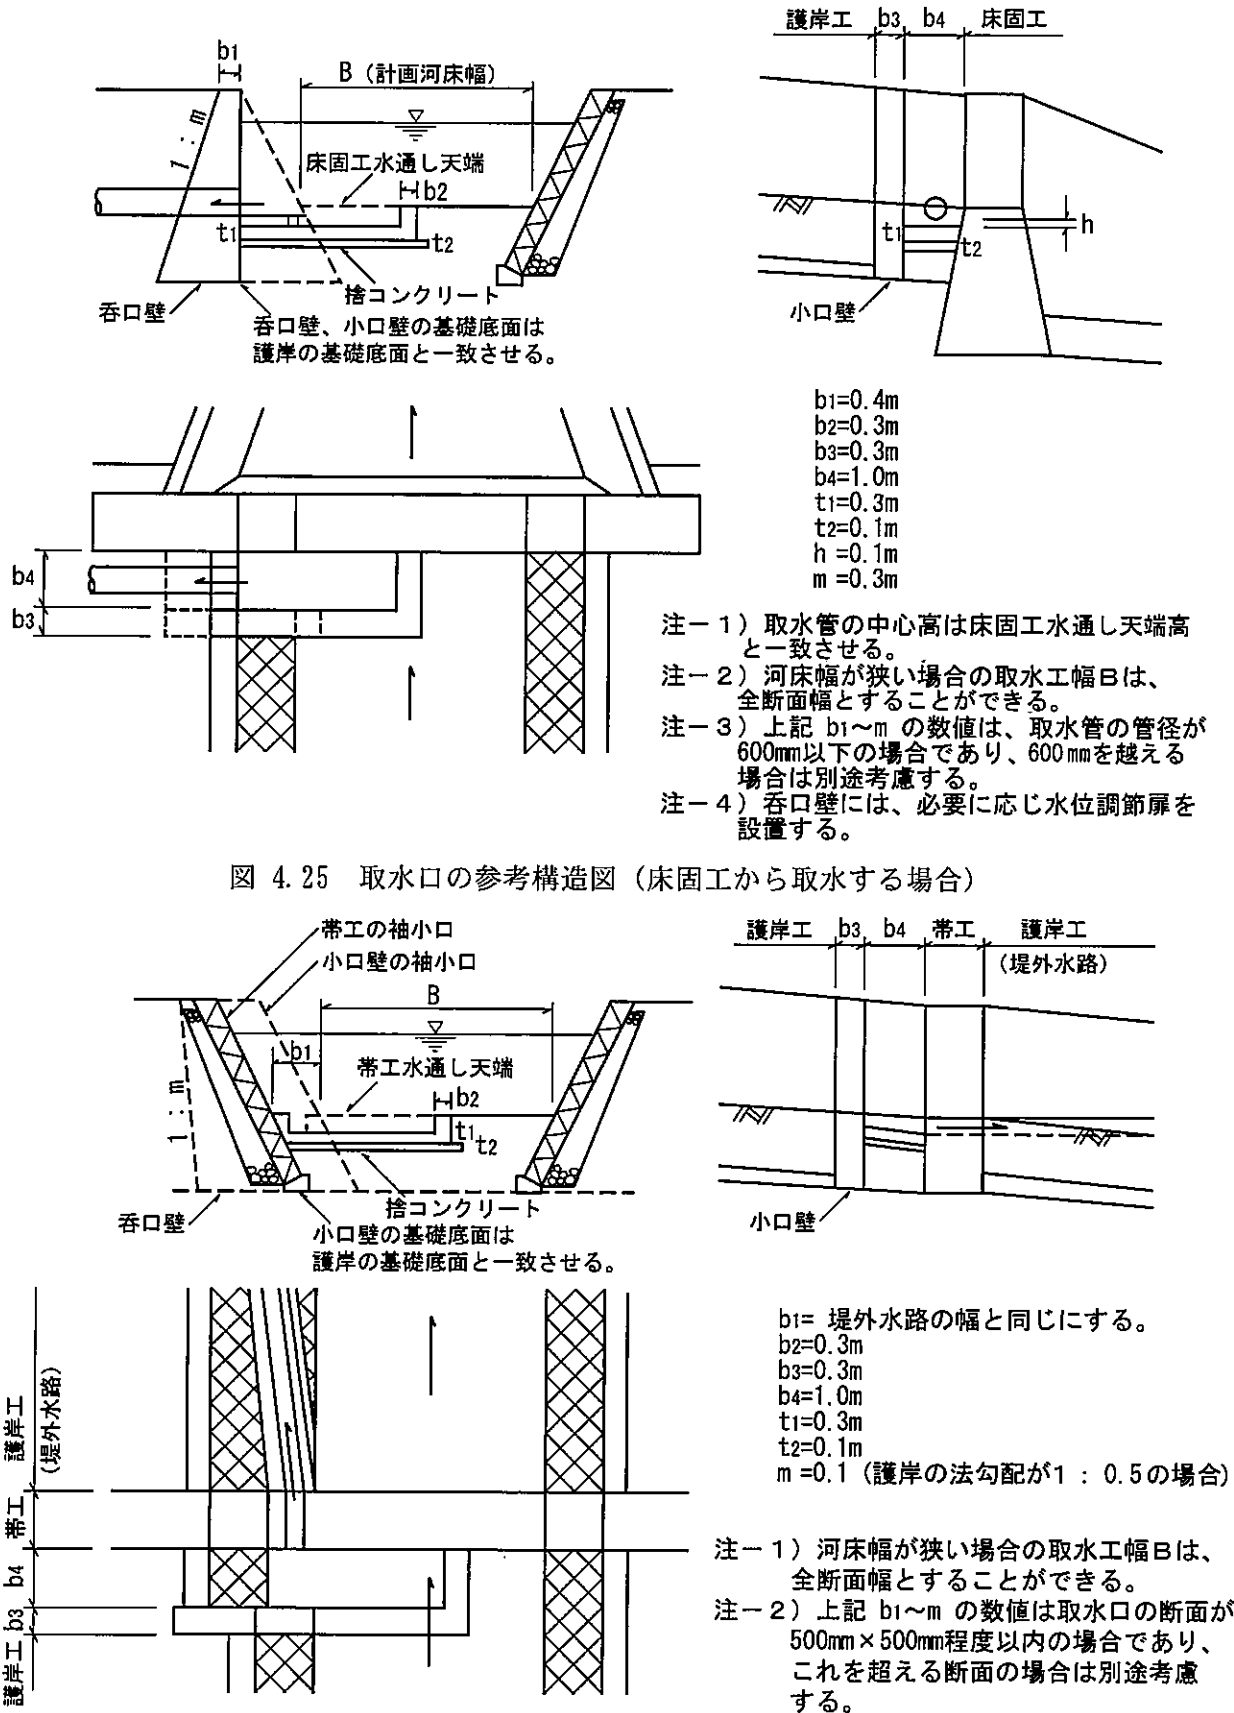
取水口の参考構造図 (床固工から取水する場合)
